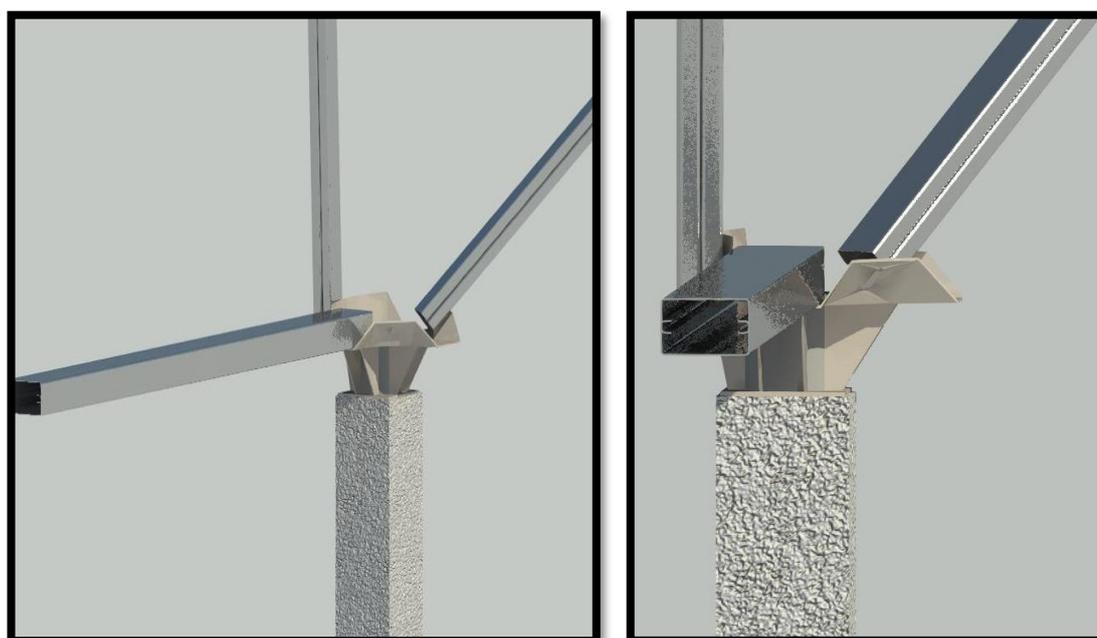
Diseño de la unión entre la estéreo-estructura y la columna de hormigón. Fuente: propia.
